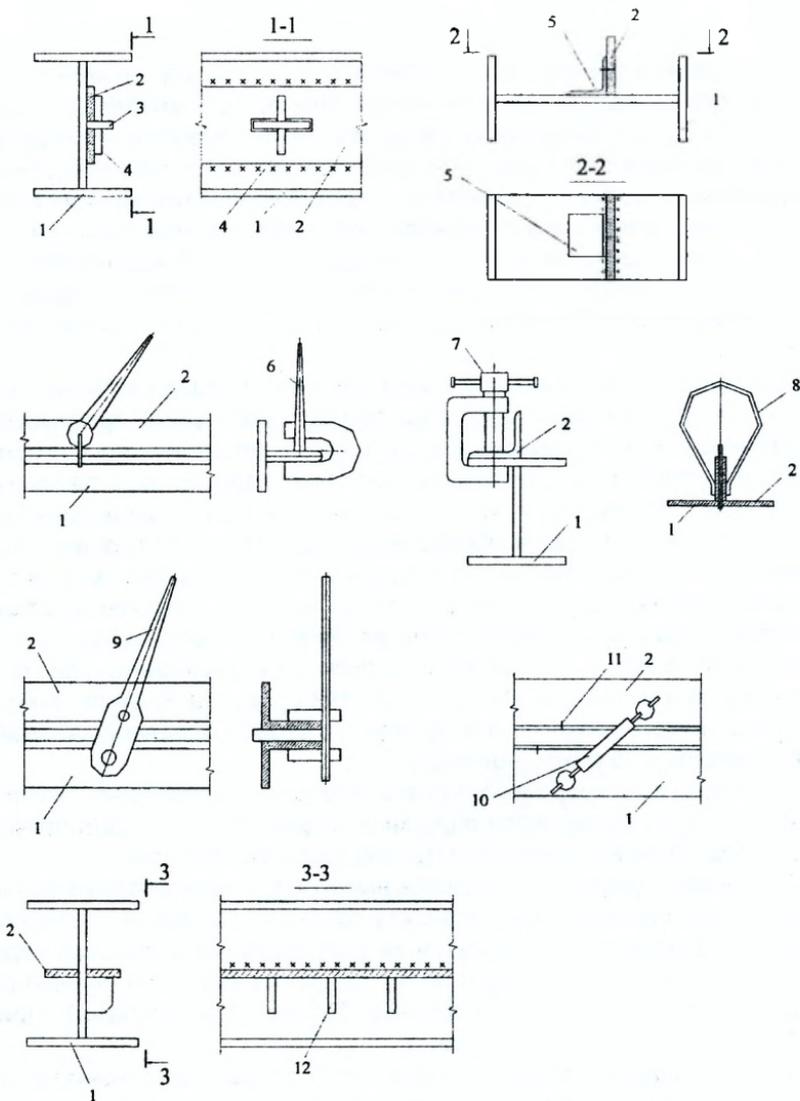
Приспособления для сборки и выверки конструкций усиления:
